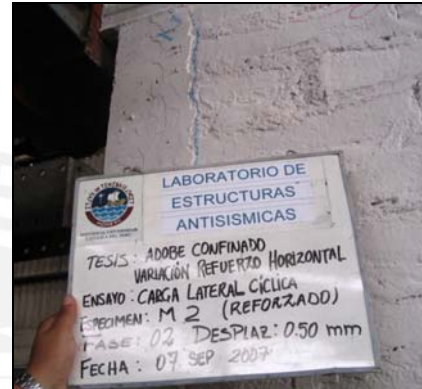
Fisura en conexión muro-columna izquierda.
